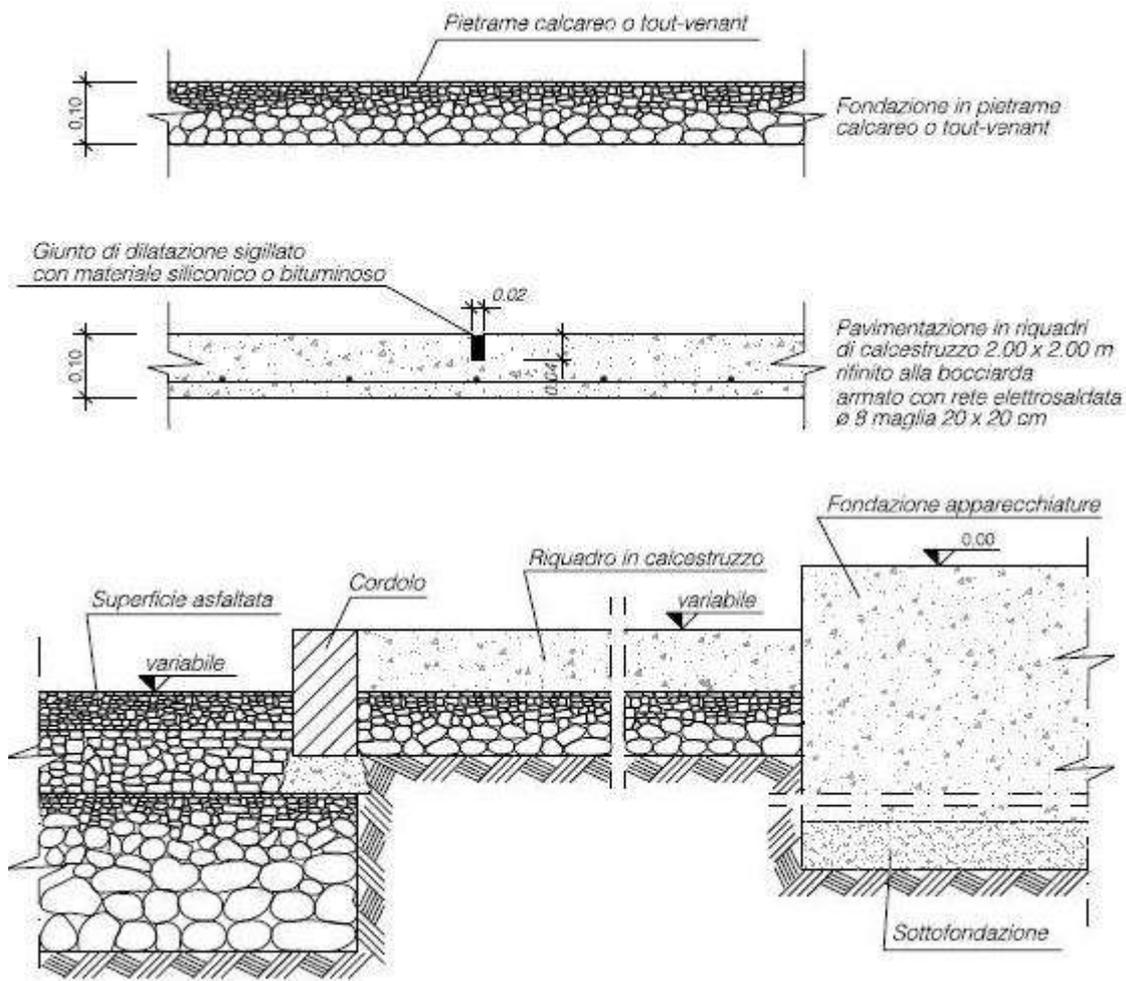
possibili schemi di posa in opera delle pavimentazioni e delle fondazioni
